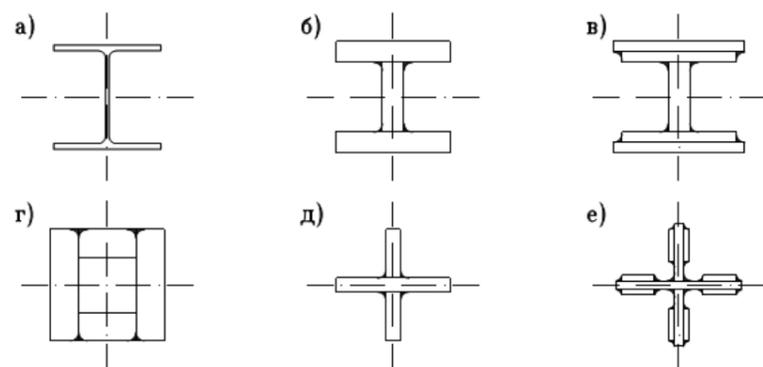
а - прокатные двутавровые; б, в - сварные двутавровые; г - коробчатого сечения; д, е - крестообразного сечения.
